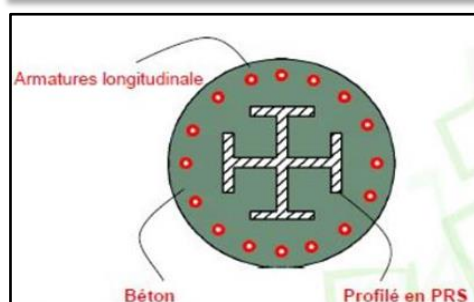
Poteau mixte (profilée PRS+ béton)
